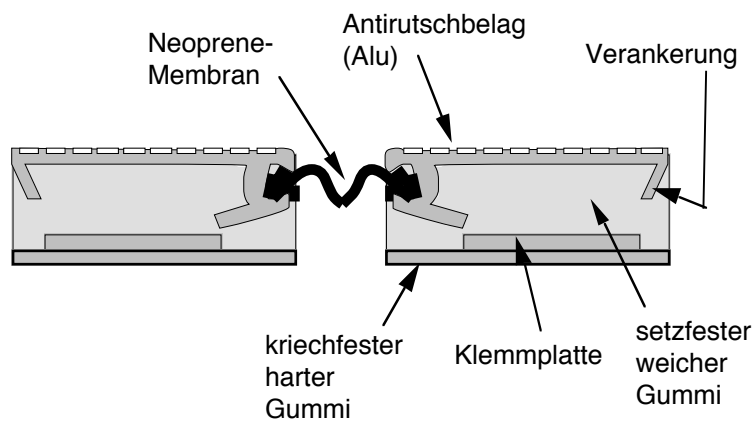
Hochbeanspruchbare Baueinheit mit Faltmembran als Fugendichtung
